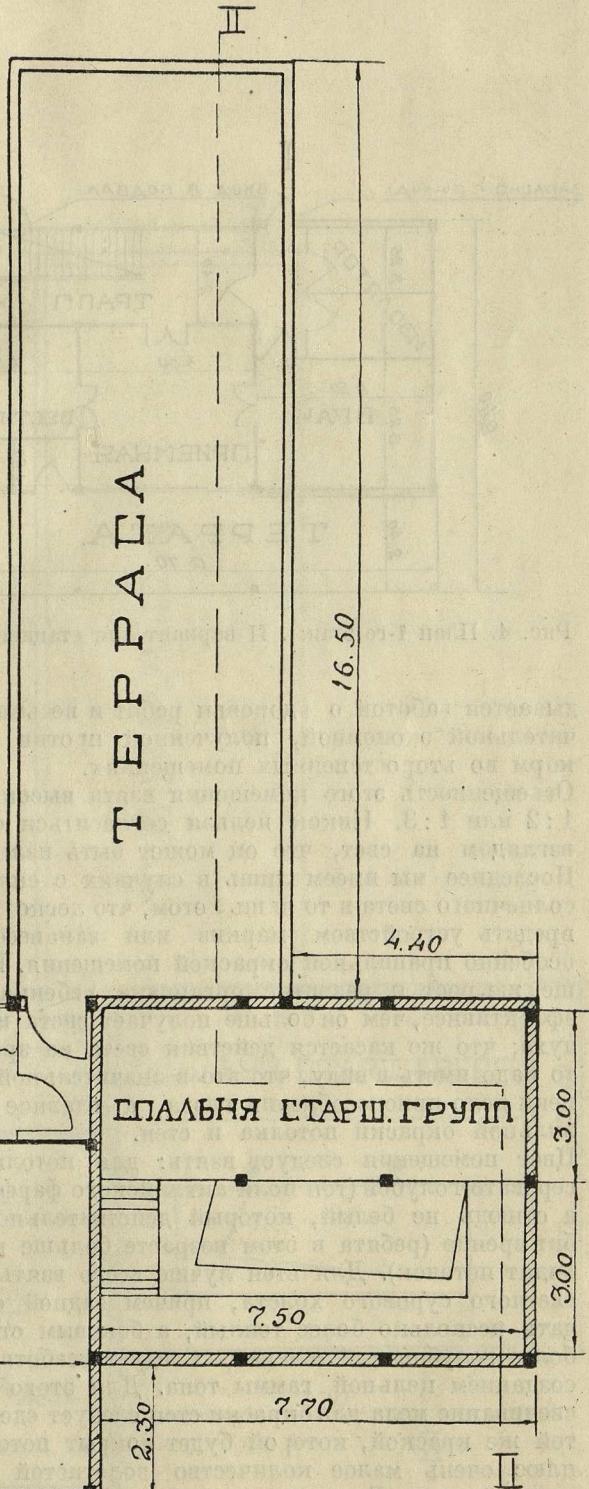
План 2-го этажа. I вариант яслей на 3 группы
